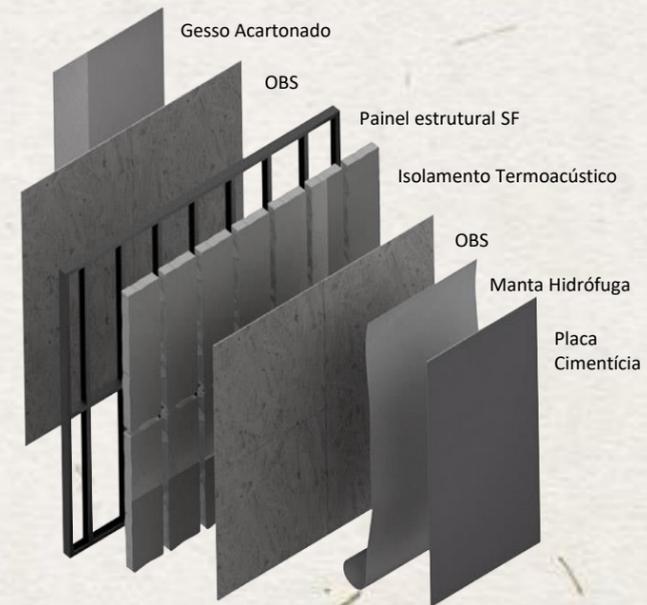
Detalhe do sistema construtivo steel frame com placa cimentícia. Fonte: <http://www.riodivisorias.com.br/steel.html>
